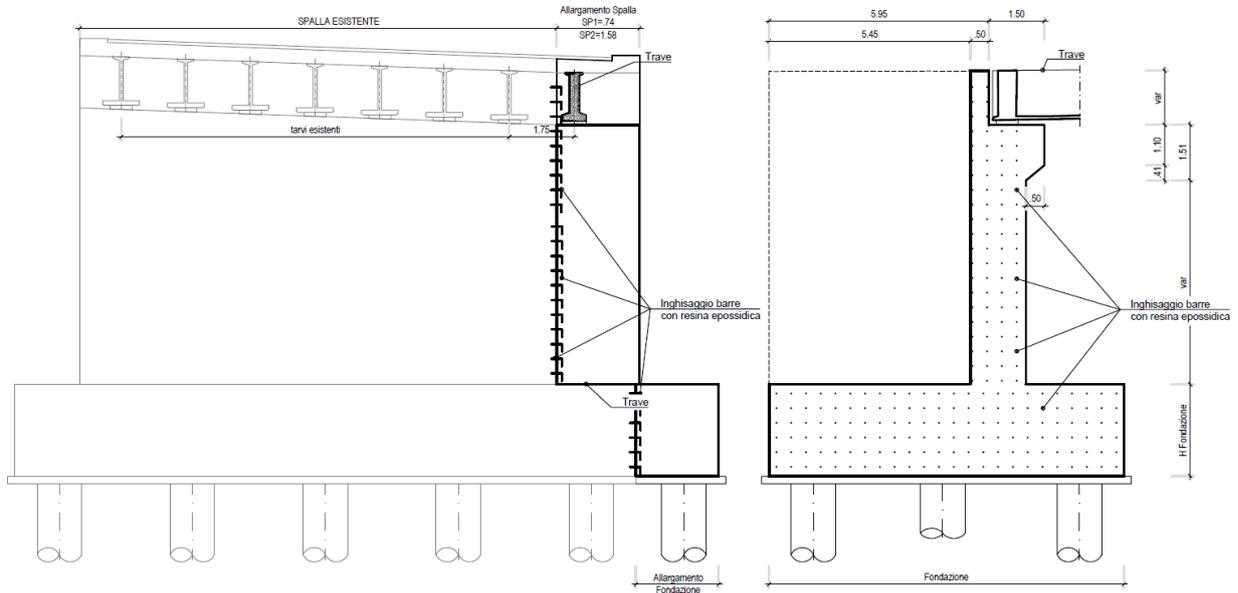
Sezione trasversale spalla in allargamento
